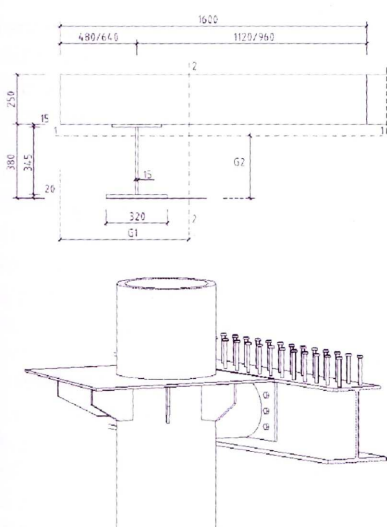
Dettaglio del collegamento fra colonne, travi e solette di piano e sua modellazione
